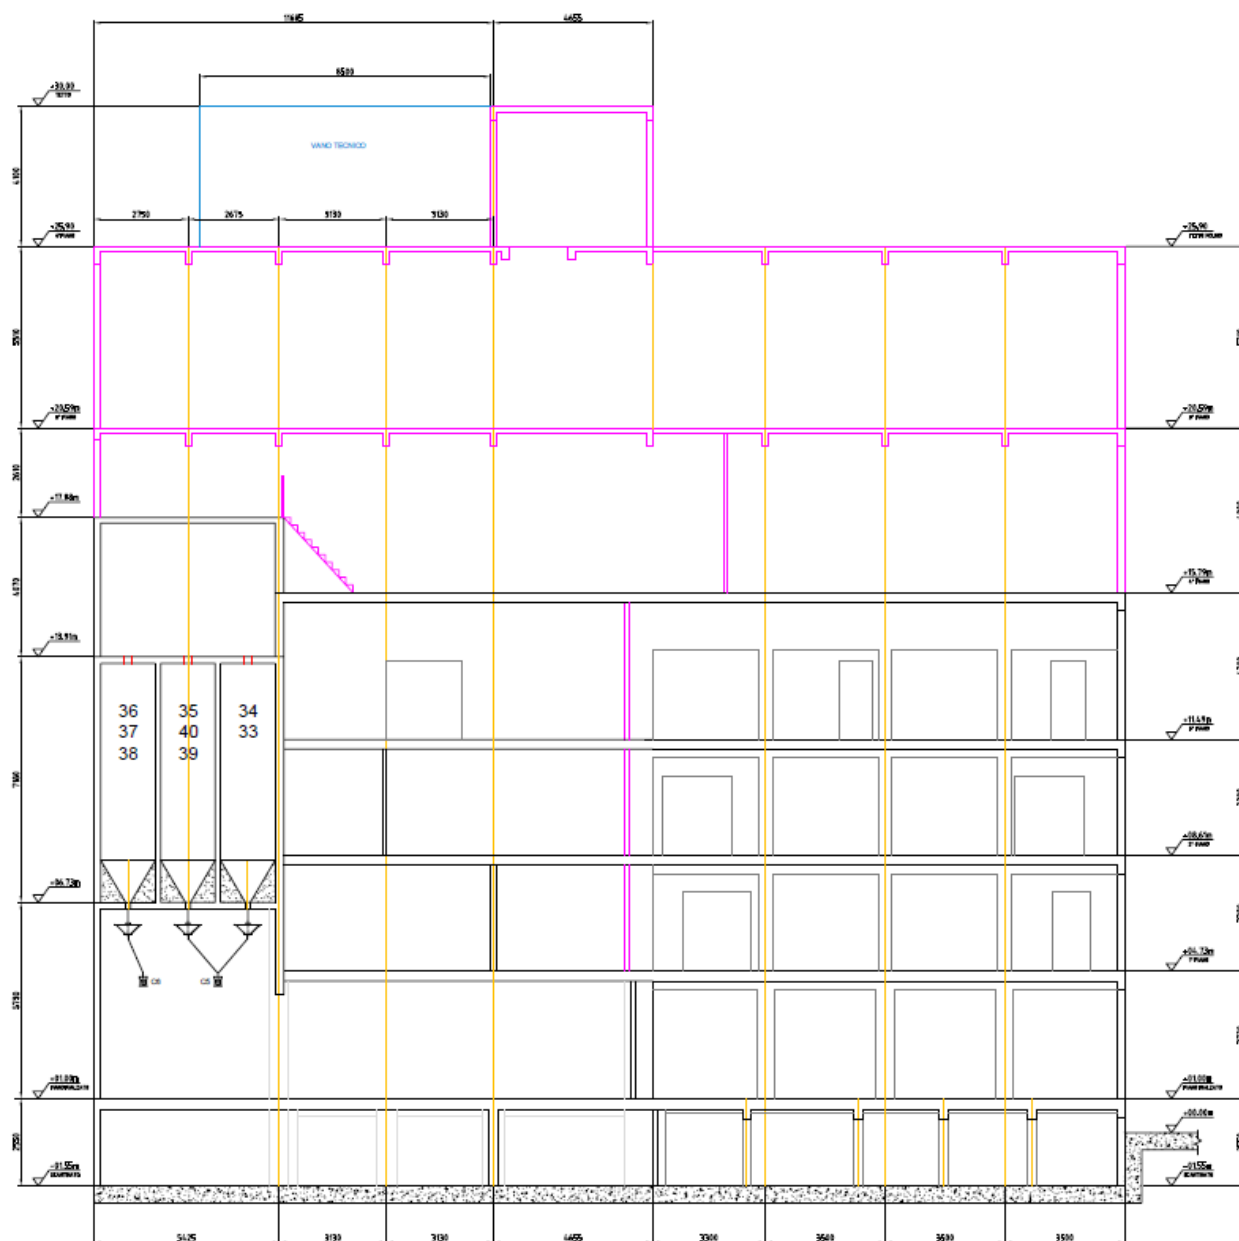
Sezione longitudinale A-A della nuova linea di macinazione "Bussola"
